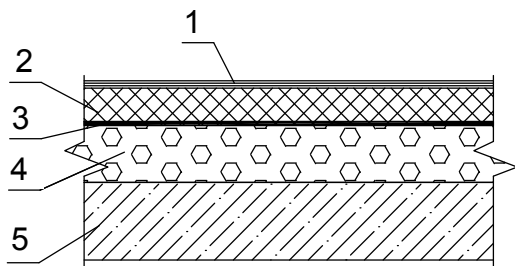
Конструкция совмещенного покрытия с прямым размещением слоев: 1 – водоизоляционный ковер (3–4 слоя наплавляемого рубероида, верхний слой с заводской защитной посыпкой); 2 – плитный негорючий утеплитель (минераловатные плиты); 3 – слой оклеечной пароизоляции; 4 – выравнивающая стяжка (цементно-песчаная), уклон кровли (гравий керамзитовый); 5 – несущая конструкция покрытия (железобетонная плита)
